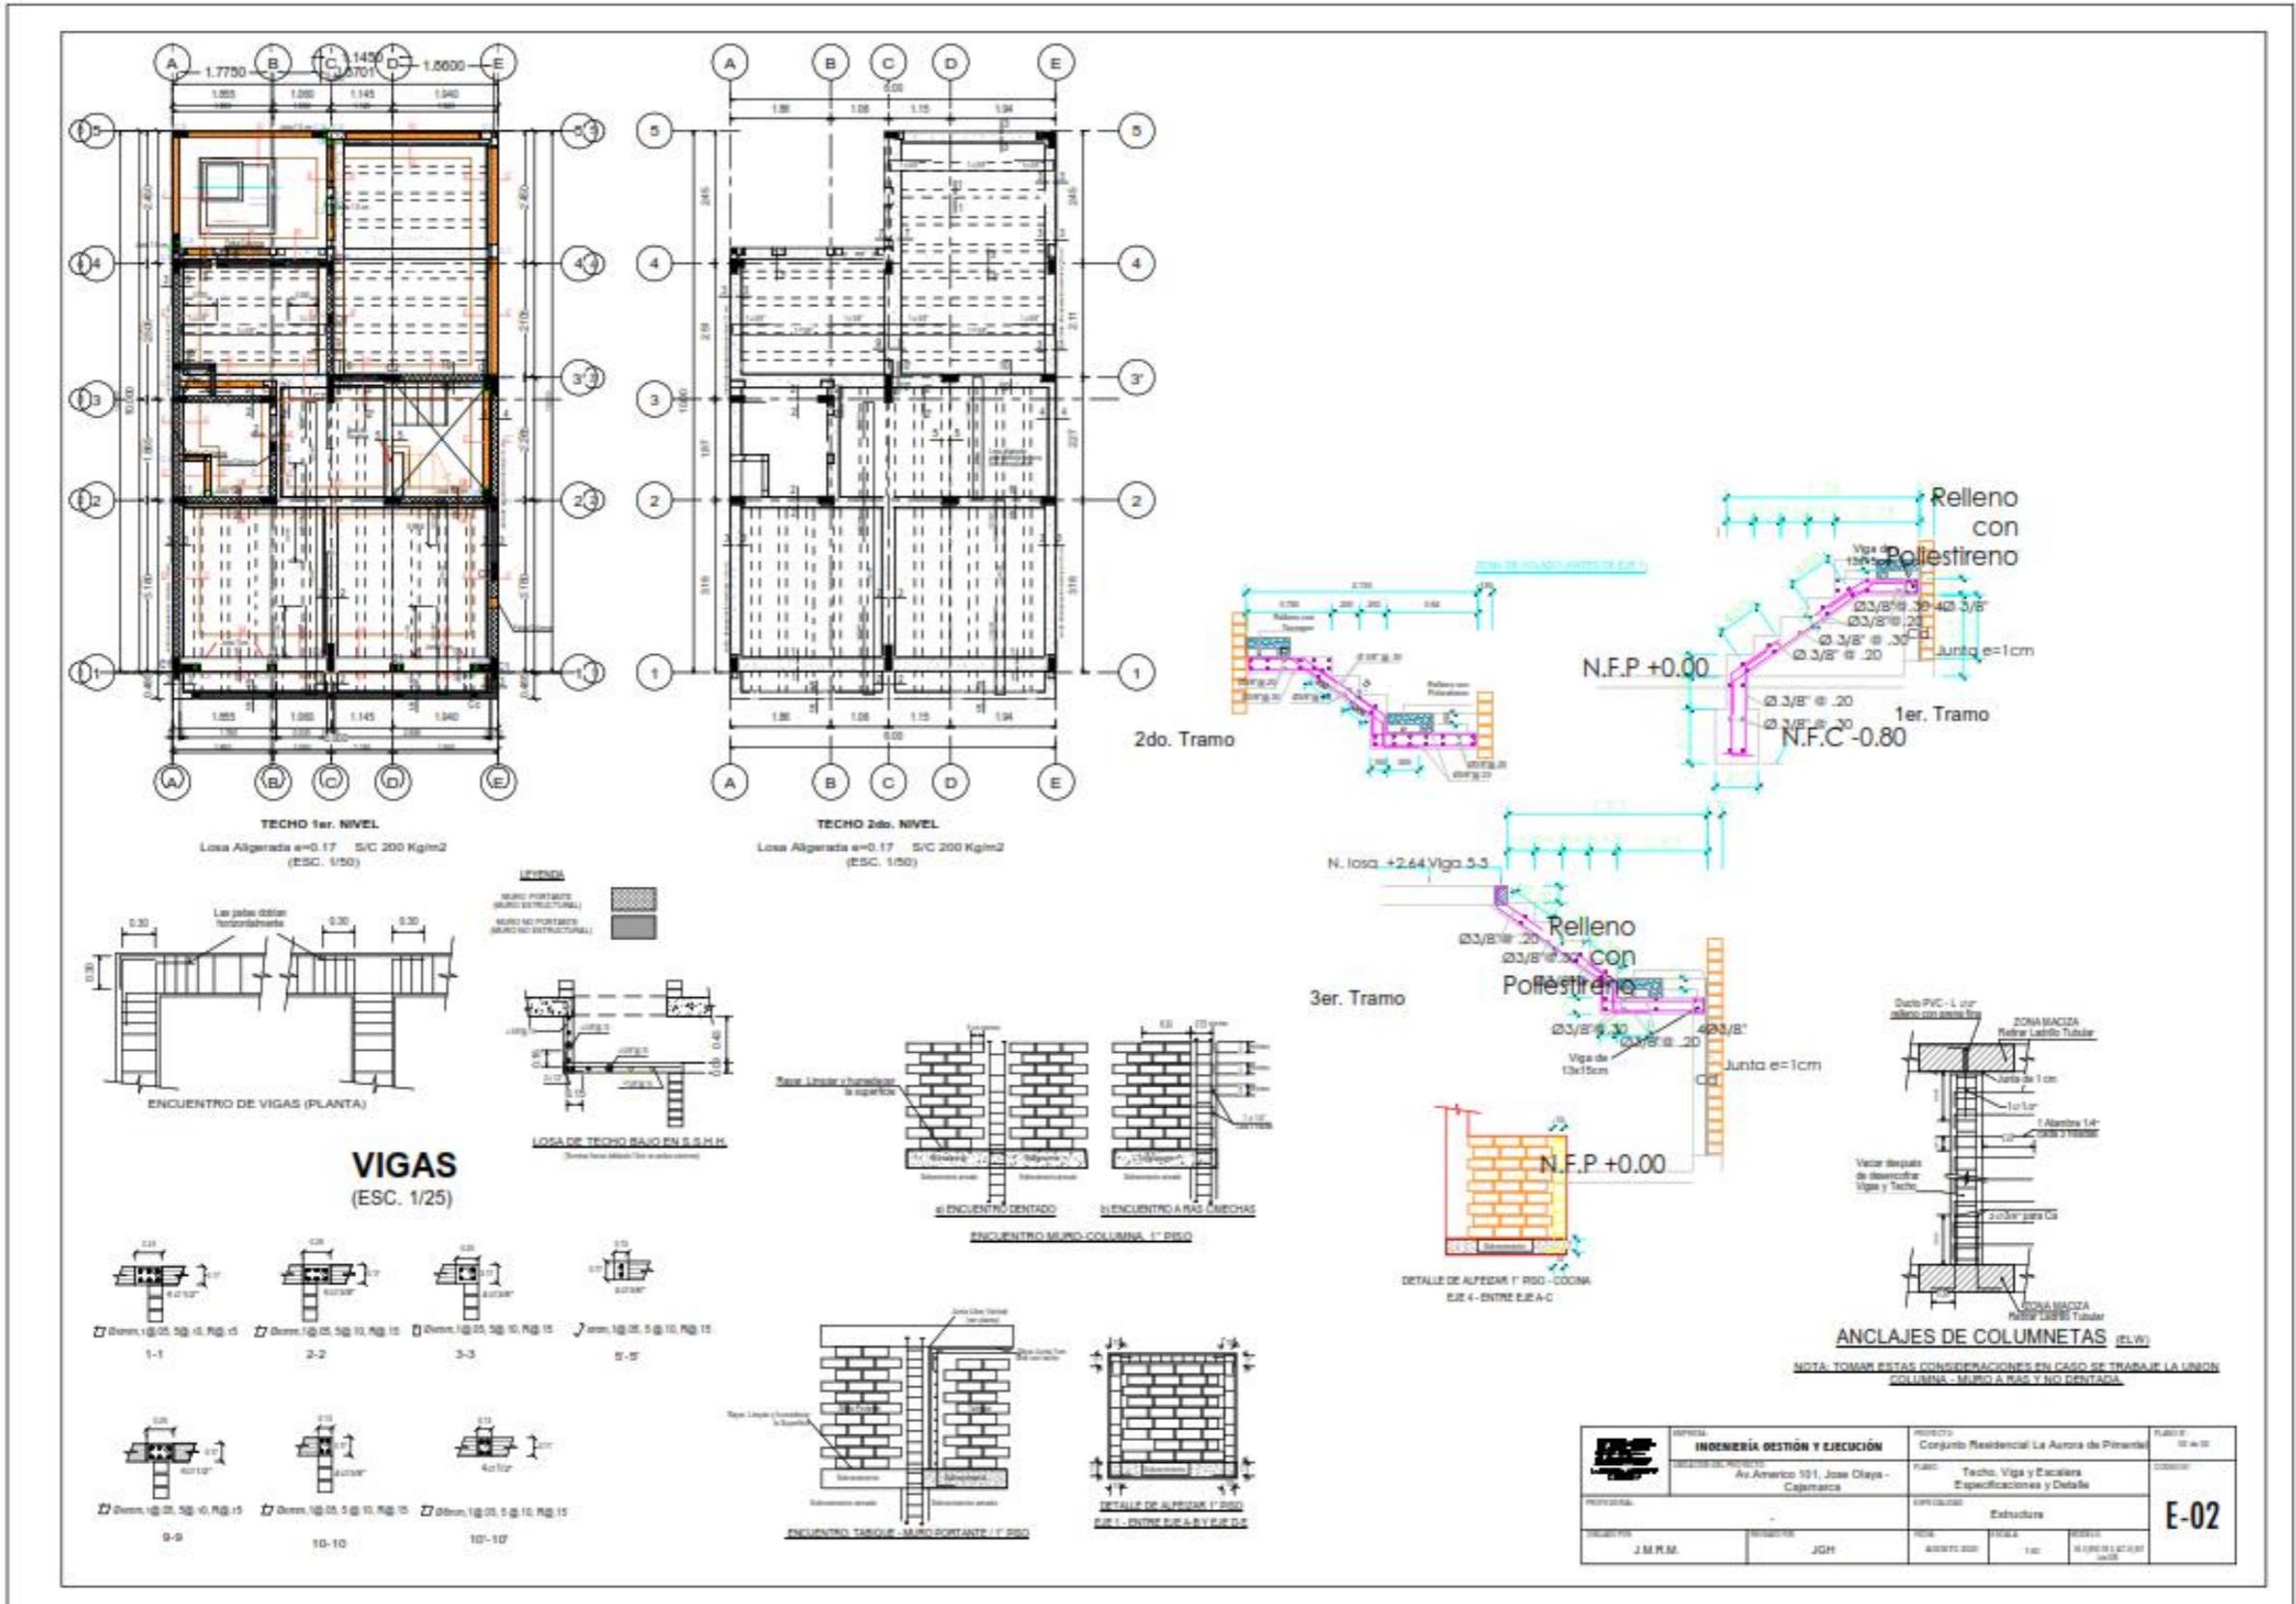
Planos de Detalle de Escalera de Arquitectura.
